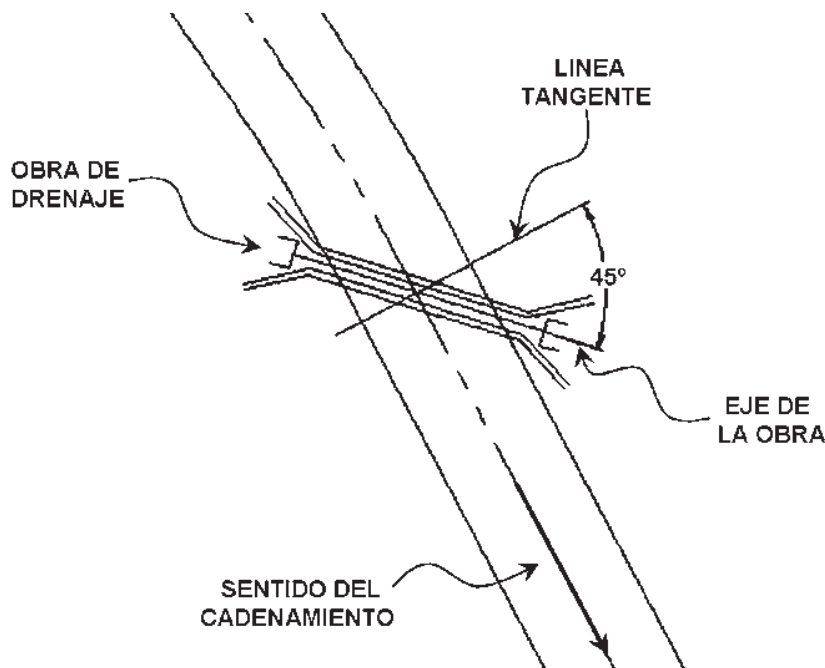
Esquema de una obra de drenaje en planta.
